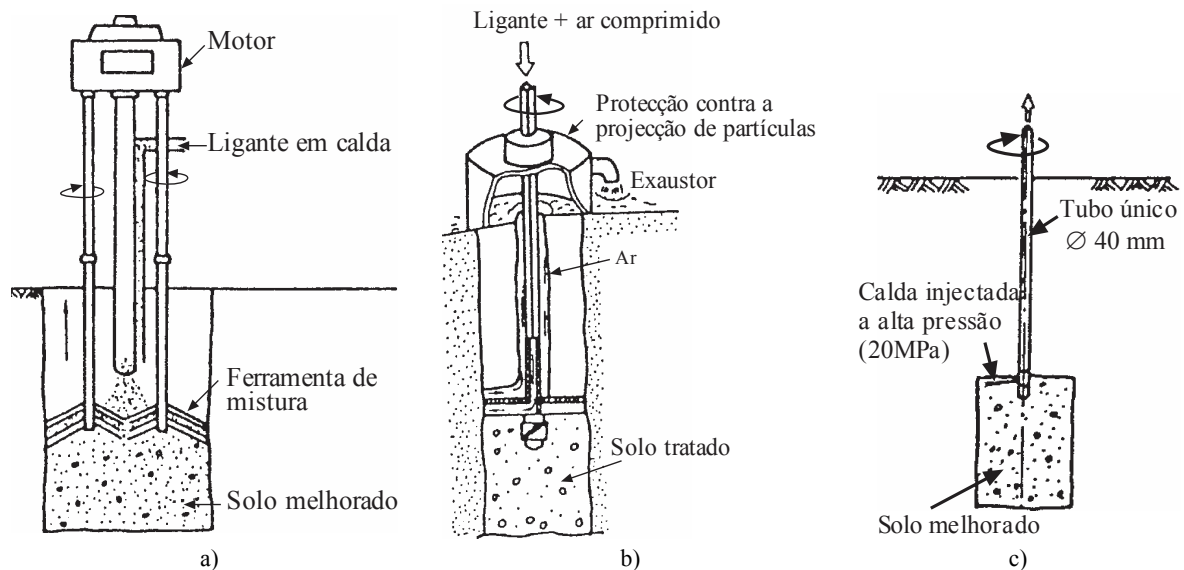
Tipos de *Soil Mixing*: a) *wet mixing*; b) *dry mixing*; c) *jet mixing* tipo 1 (adaptado de Porbaha, 1998)
